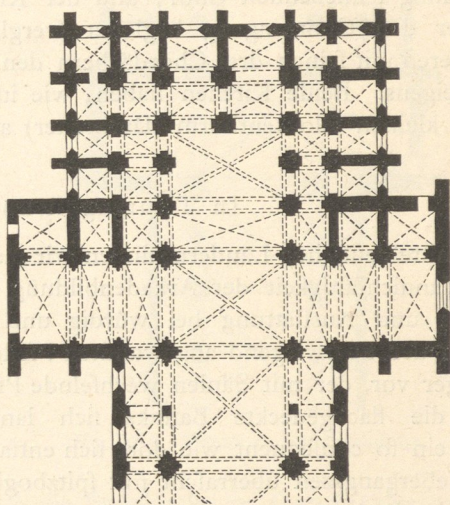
Grundriss von Ebrach. (Nach v. Quast.)
